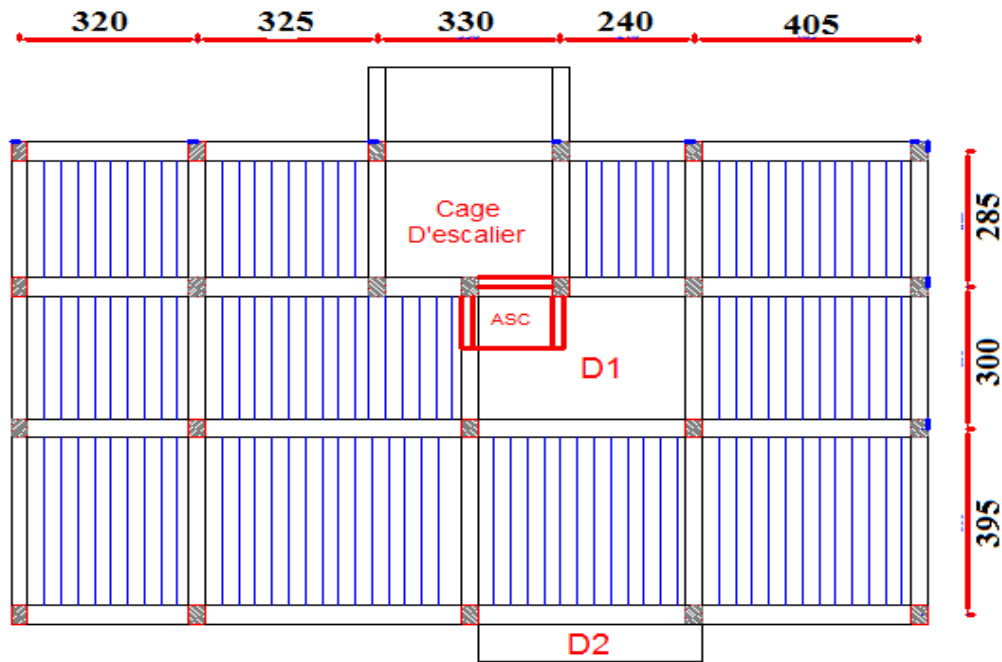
Schéma de la disposition des poutrelles du RDC.
